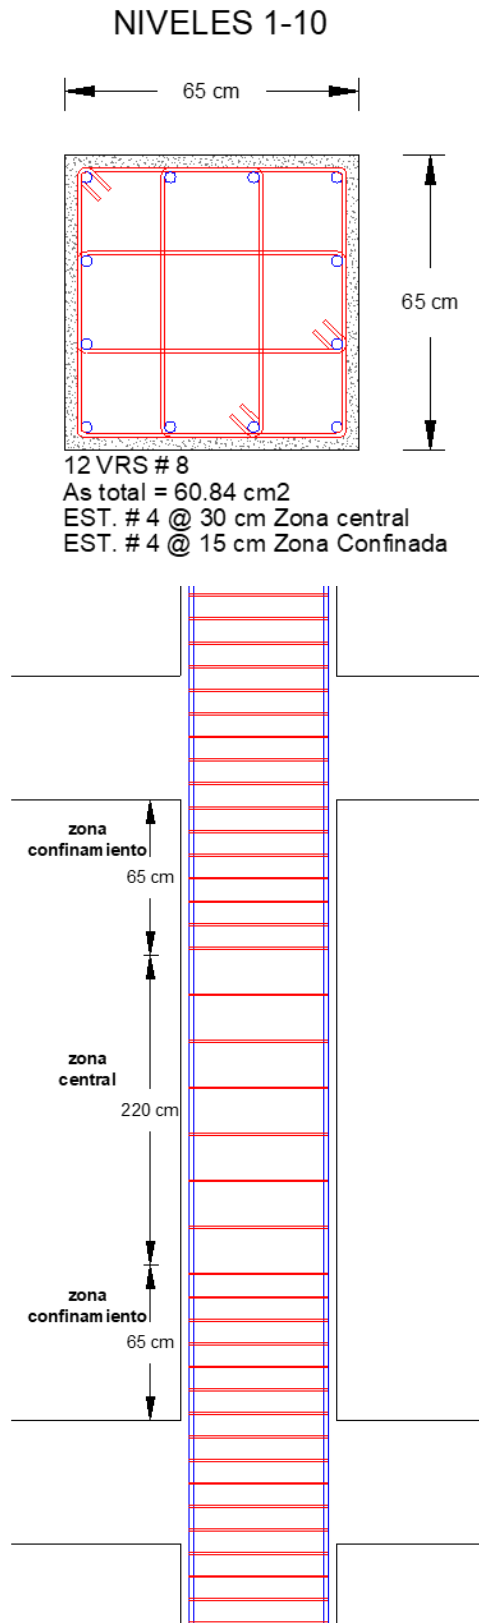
Detallado del refuerzo en columnas para el sistema dual
